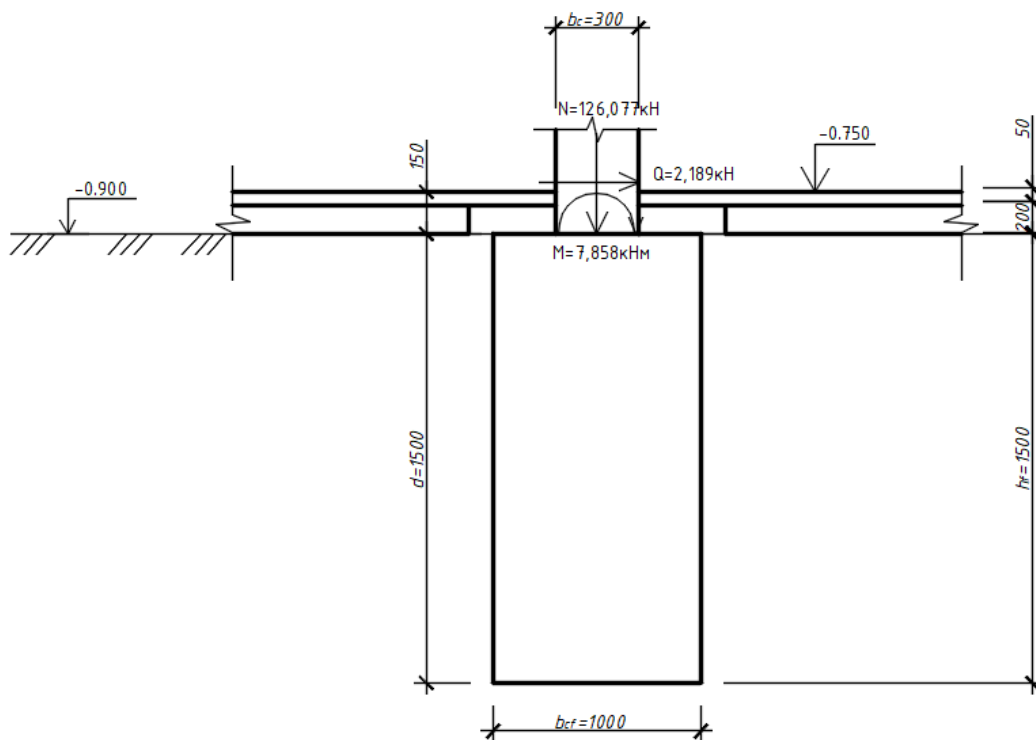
Схема розрахункових навантажень на підколонник
